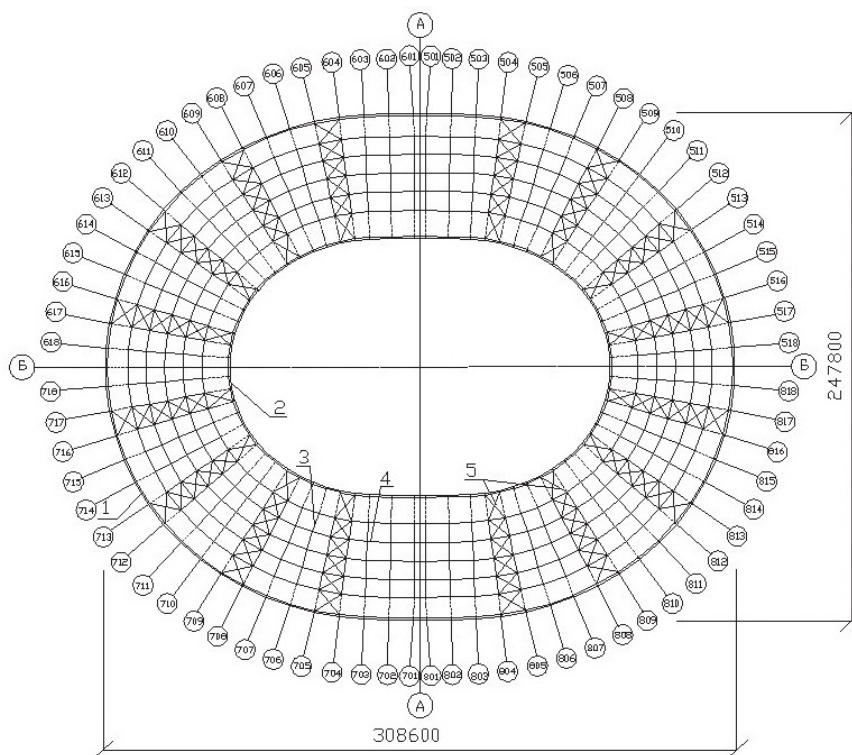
Схема элементов покрытия БСА: 1 – наружный опорный контур; 2 – внутренний контур; 3 – радиальные балки; 4 – кольцевые фермы; 5 – горизонтальные связи
